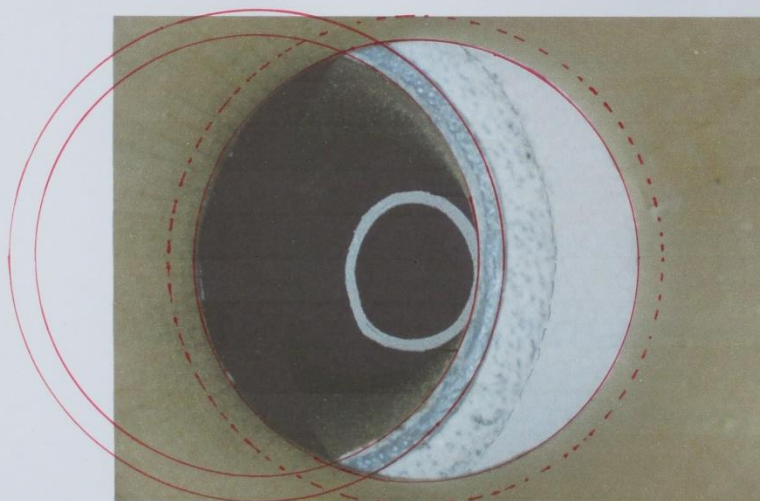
Situatie met alleen afschuiving, dus zonder tussenruimte (zie foto 4)
